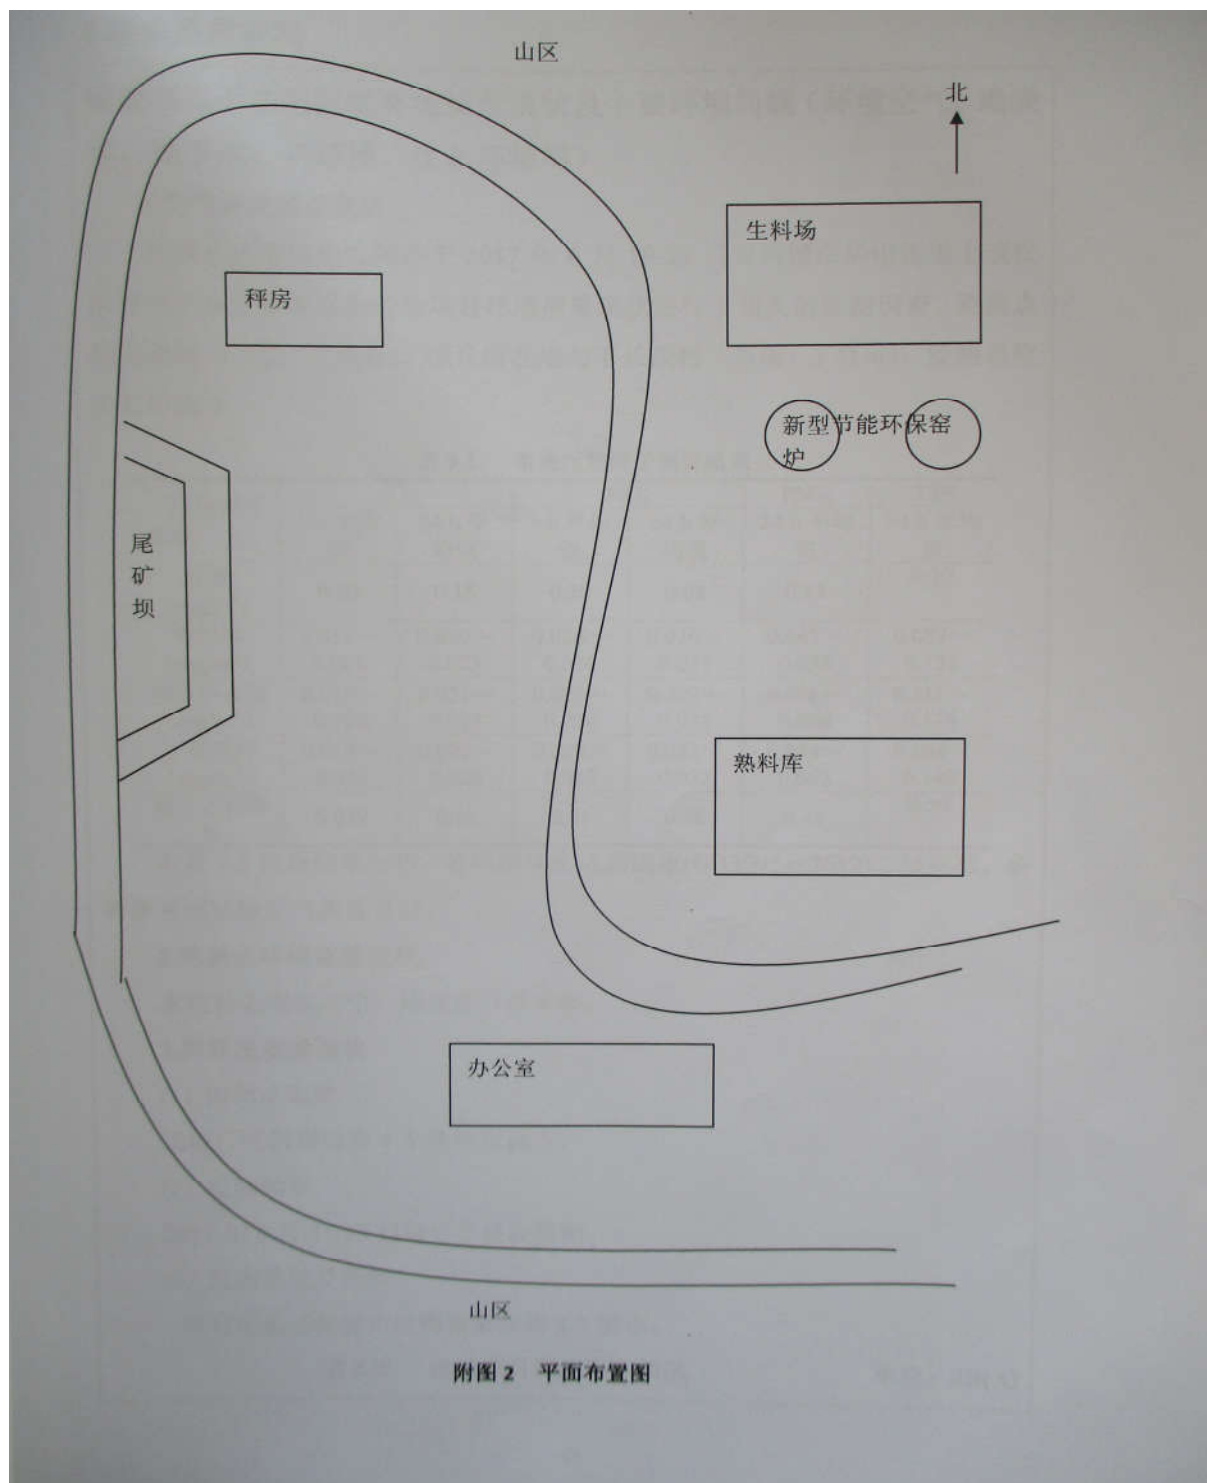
兴城市华山街道上茂松山白灰厂厂区总平面布置图
